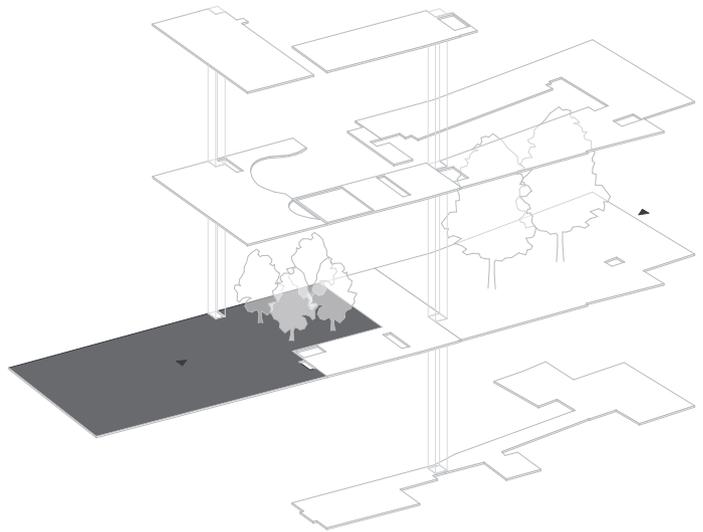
| Grundriss Erdgeschoß. Gemeinschafts- & Wasch-Center 205
